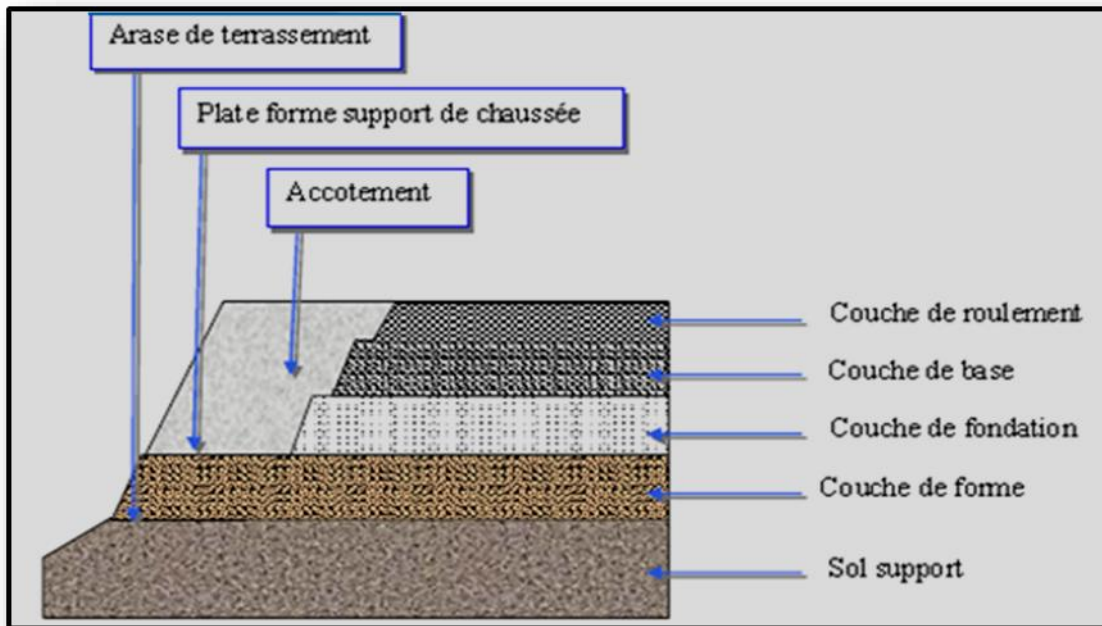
4 : Constitution d'une structure de chaussée type [13].
